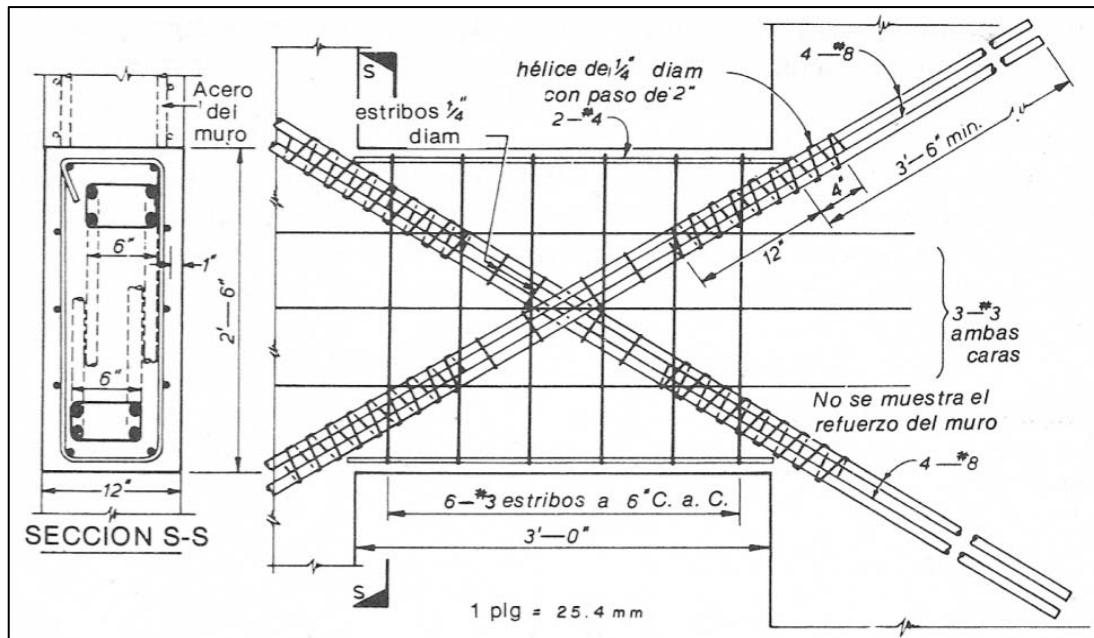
Arreglo sugerido del acero en una viga de acoplamiento reforzada diagonalmente
